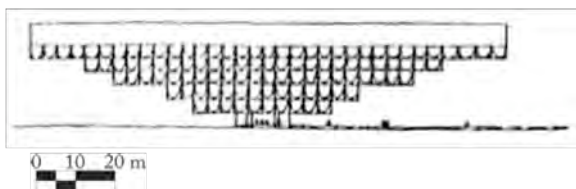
Museu Expo Barra 72 (1969) – elevação.
